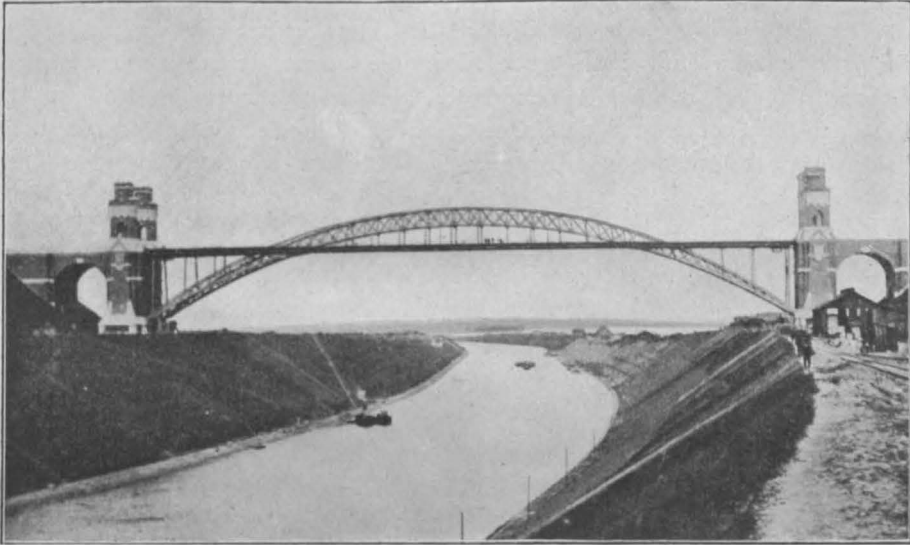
Straßen- und Eisenbahnbrücke über den Nordostseekanal bei Grünenthal.
